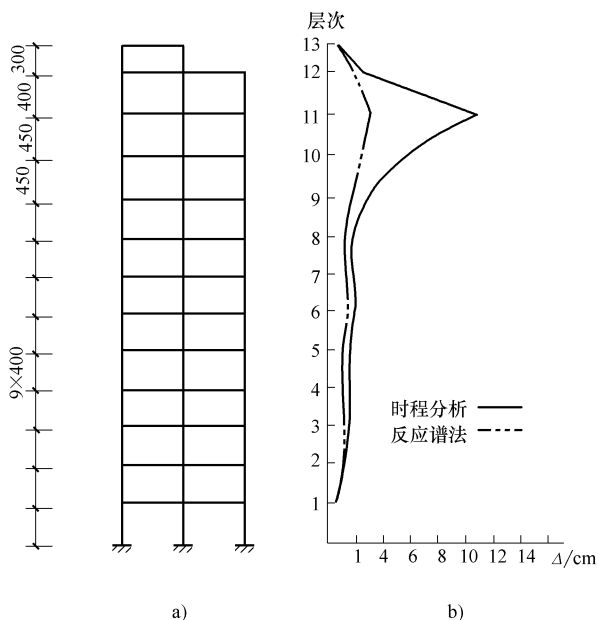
钢筋混凝土高层框架厂房弹塑性地震反应分析
